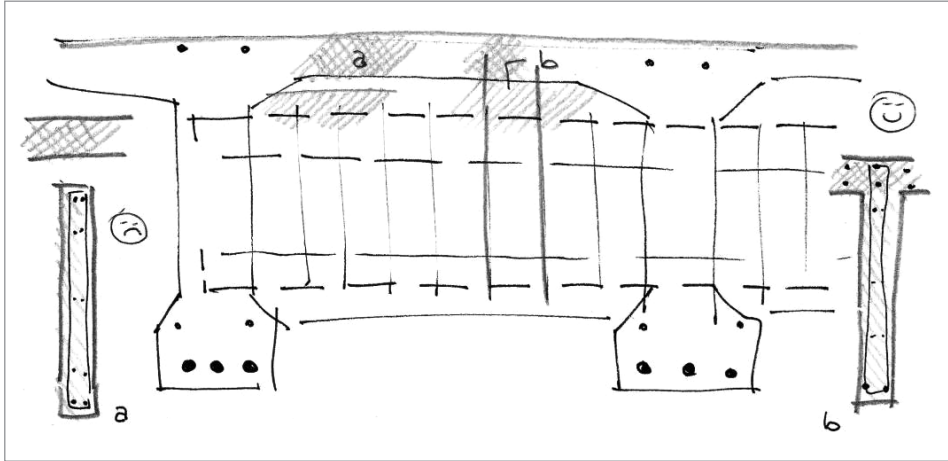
Armature nel traverso staccato e solidale alla soletta
